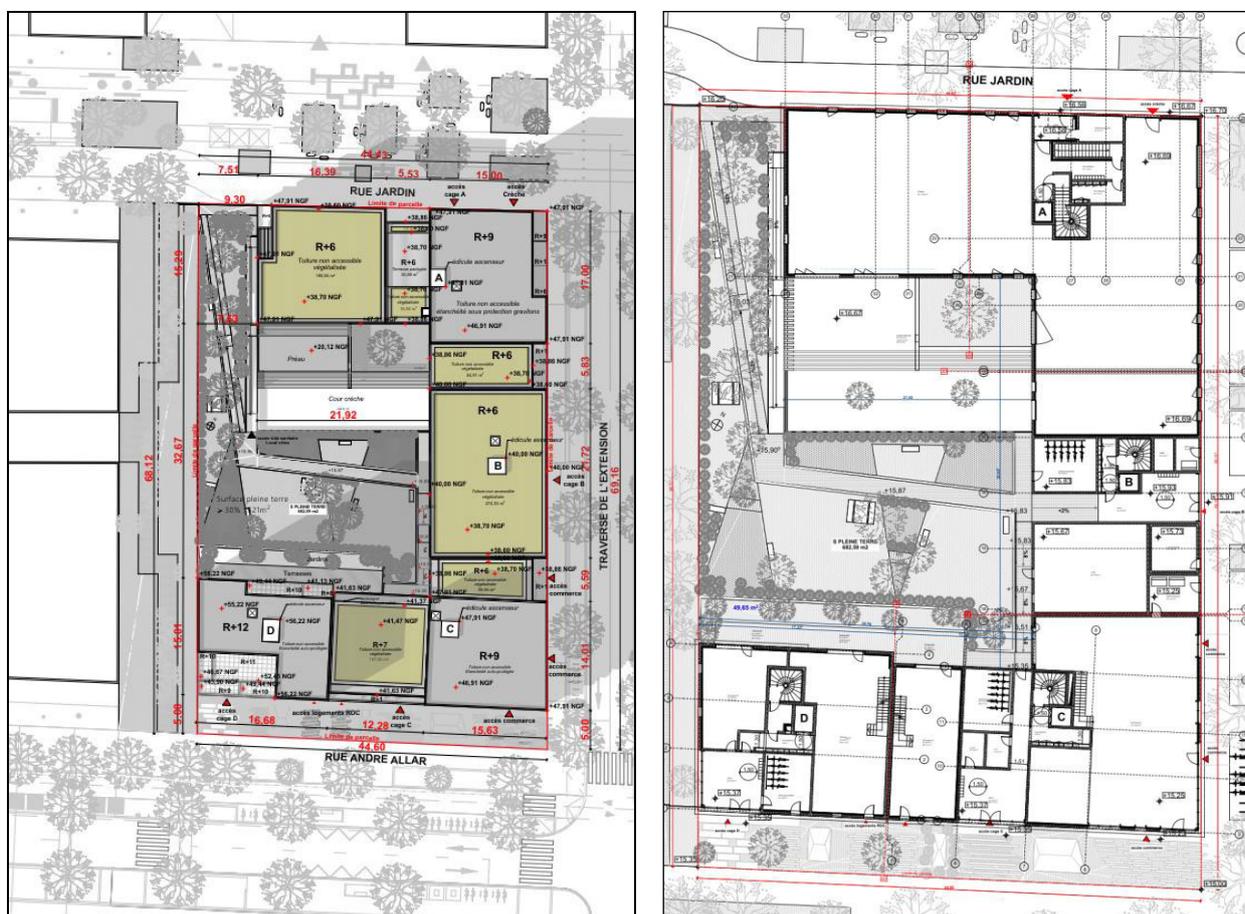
Plan de toiture et plan de rez-de-chaussée de l'îlot 5C3 (source : Linkcity, 2019)
